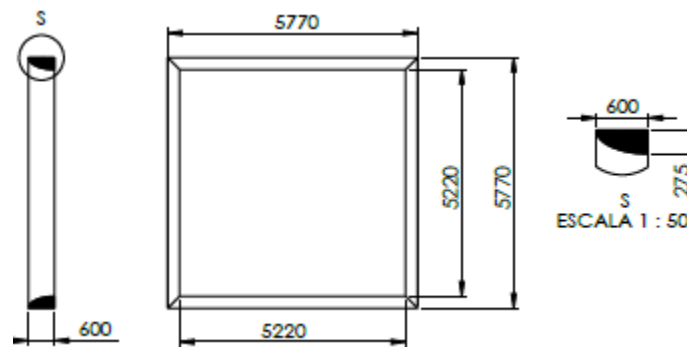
Detalle constructivo de boca de entrada. Fuente: Generación propia SolidWorks 2018.
